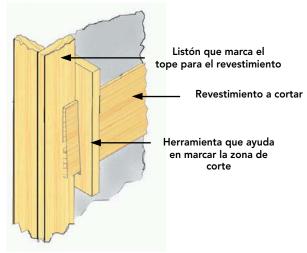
27: Uso de la pieza que ayuda a determinar el corte requerido para una pieza del revestimiento.
